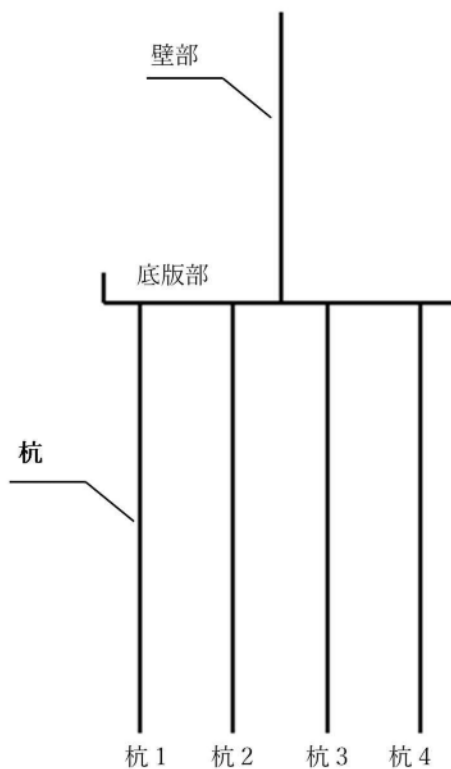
防潮扉 2 基礎 杭番号位置図
